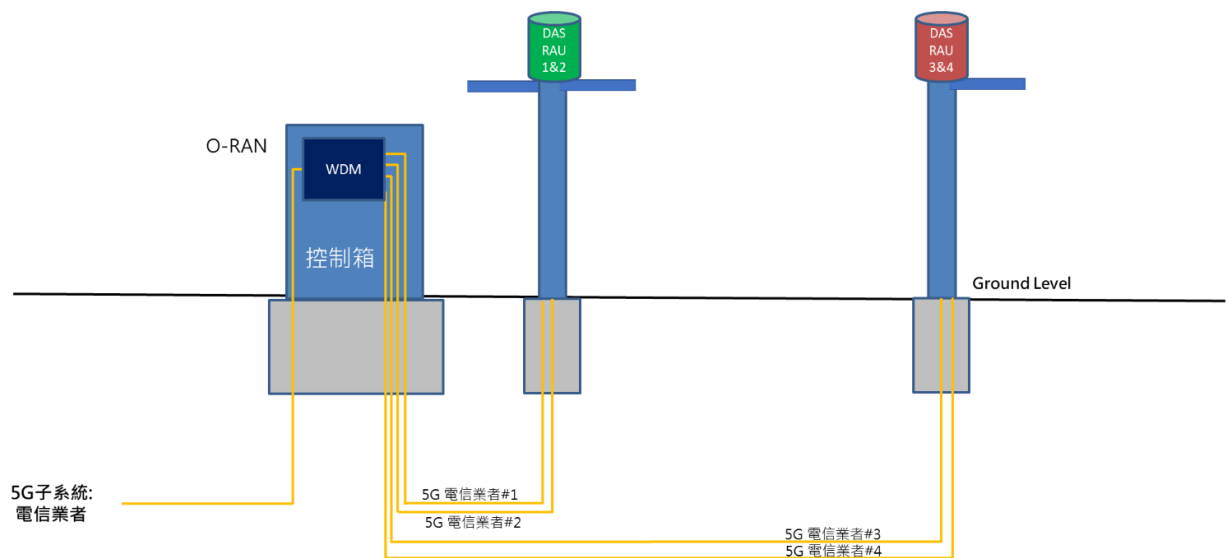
DAS PVC 管線預埋示意圖
